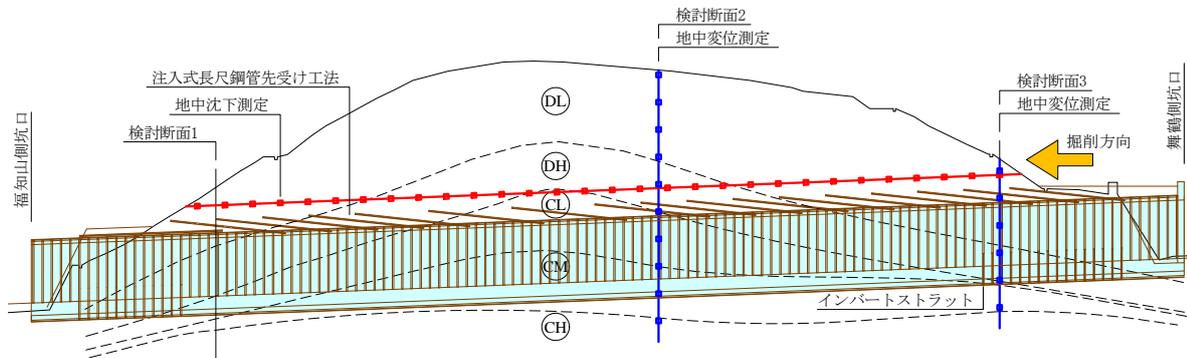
私市円山トンネル（Ⅱ期線）の施工・計測工概要図
